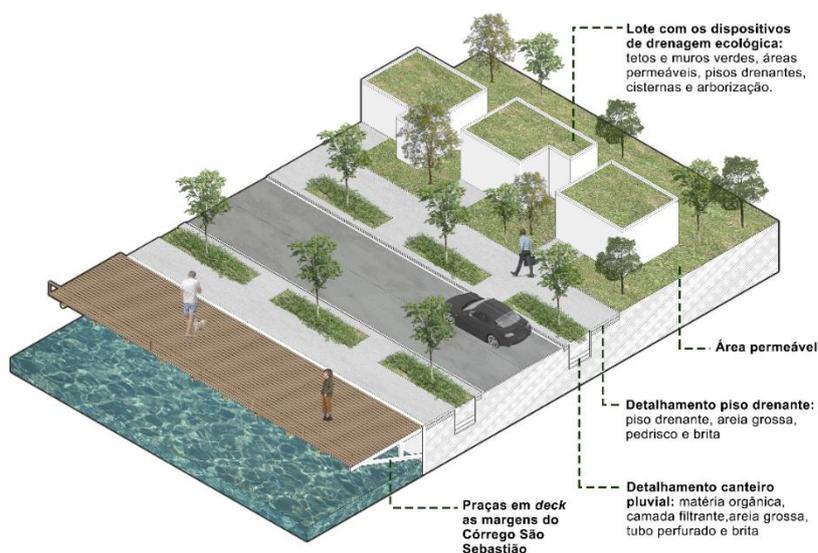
Ensaio espacial de pequenas praças em *deck* ao longo do Córrego São Sebastião.
